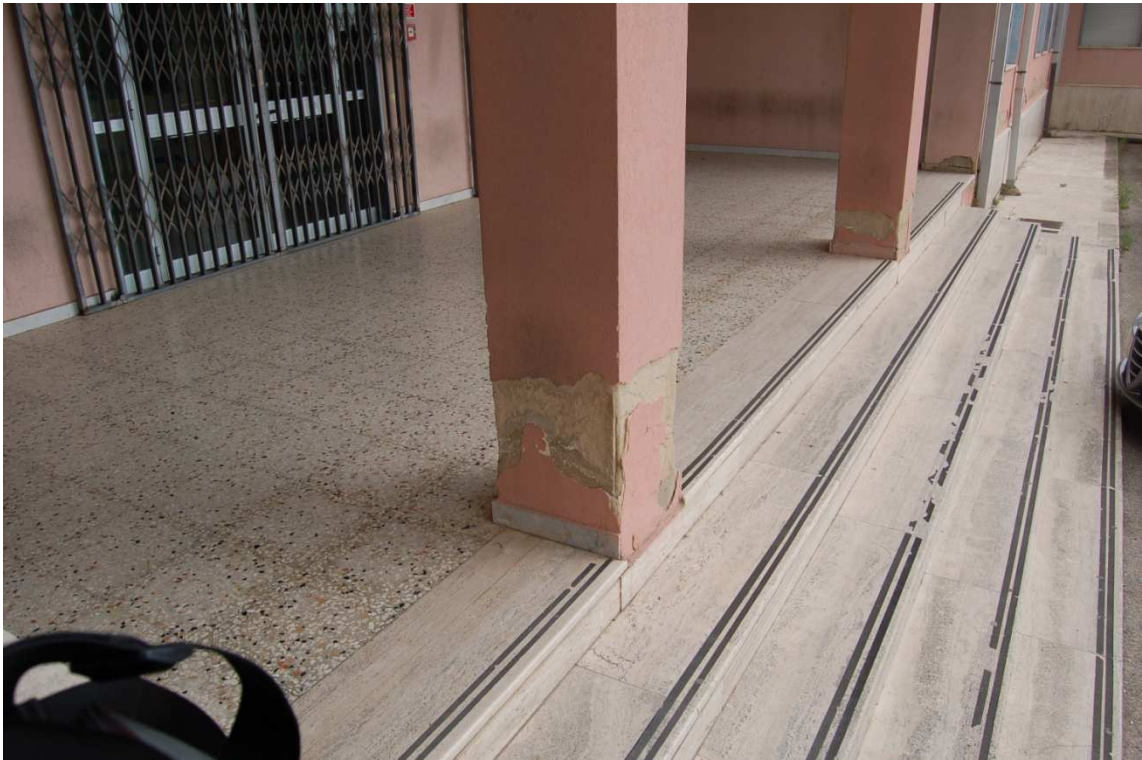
ammaloramento intonaco di finitura pilastri ingresso
